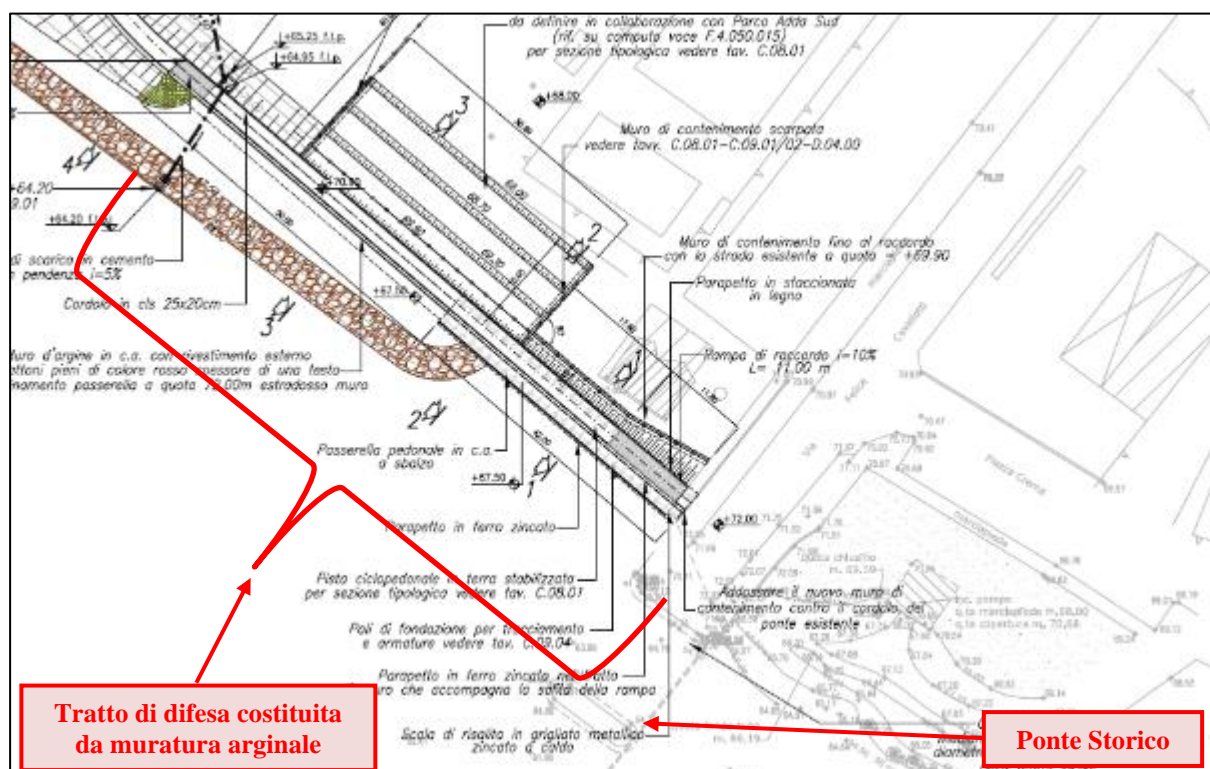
Planimetria di progetto muro arginale in sponda sinistra a monte del Ponte Storico
